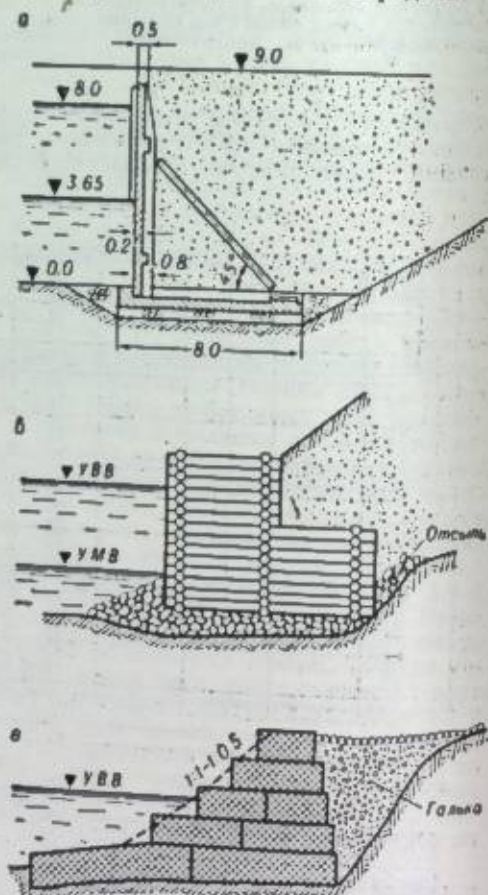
Крепление берегов: железобетонной (а), рязевой (б) и габионной (в) стенками.
